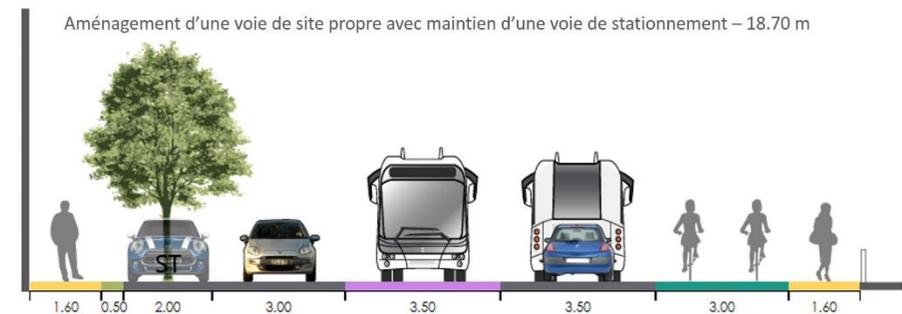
Variante – Aménagement d'une voie de site propre avec maintien d'une voie de stationnement
